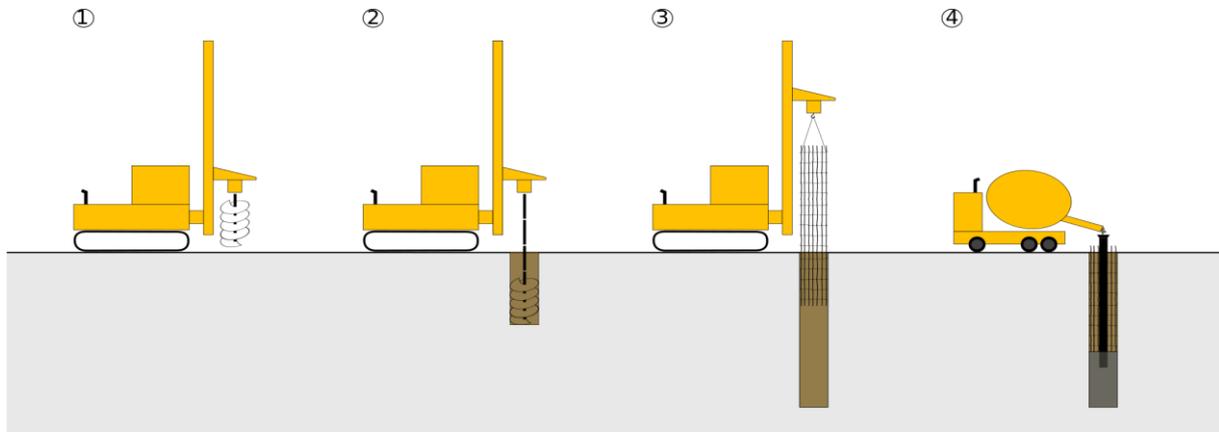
LES PIEUX DE FONDATION, SOURCE WIKIPEDIA.
